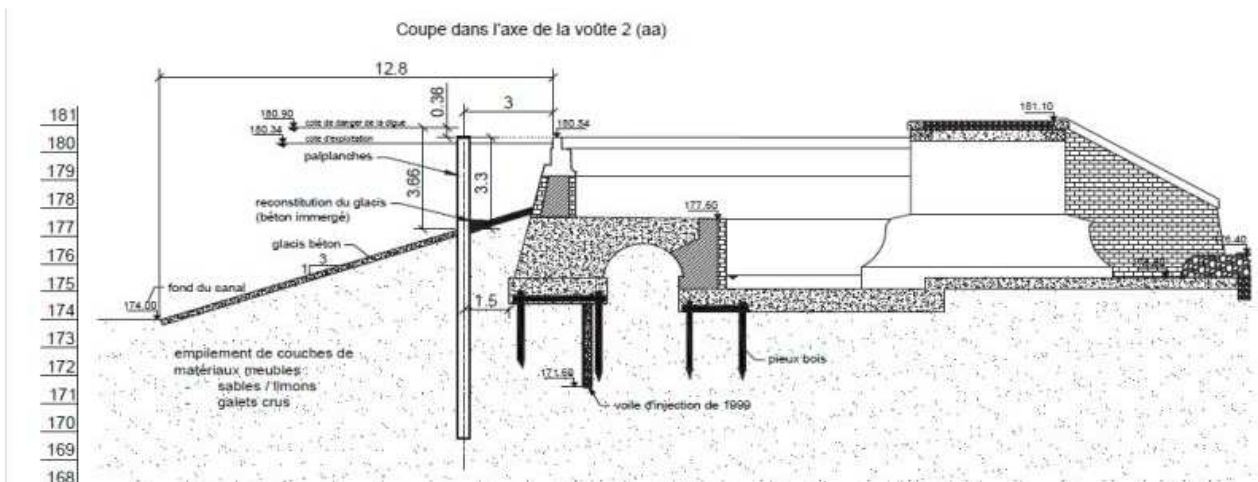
Coupe du projet d'implantation du rideau de palplanches (extrait FONDASOL)
